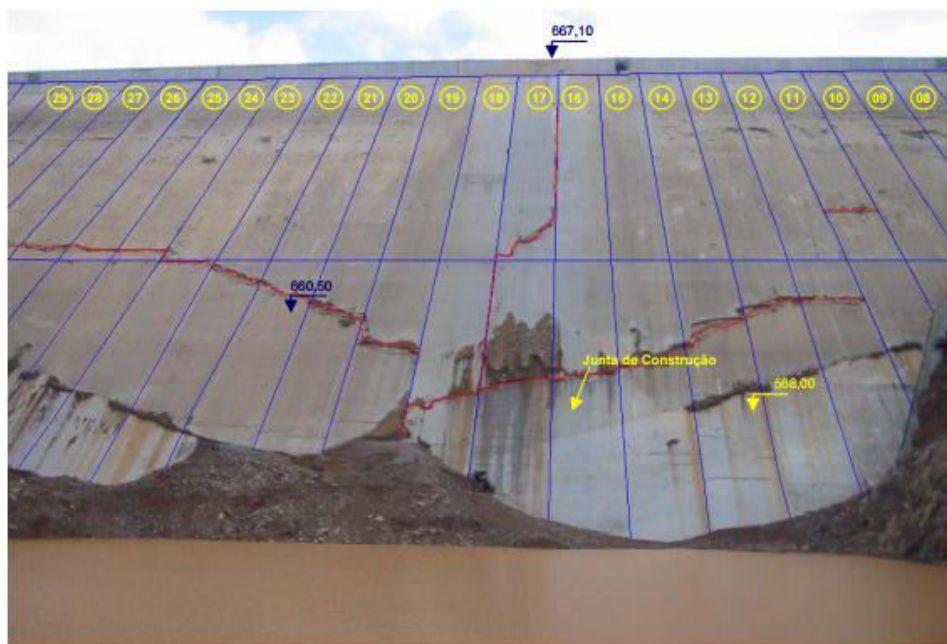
TRINCAS NA FACE DE CONCRETO DA BARRAGEM DE CAMPOS NOVOS
